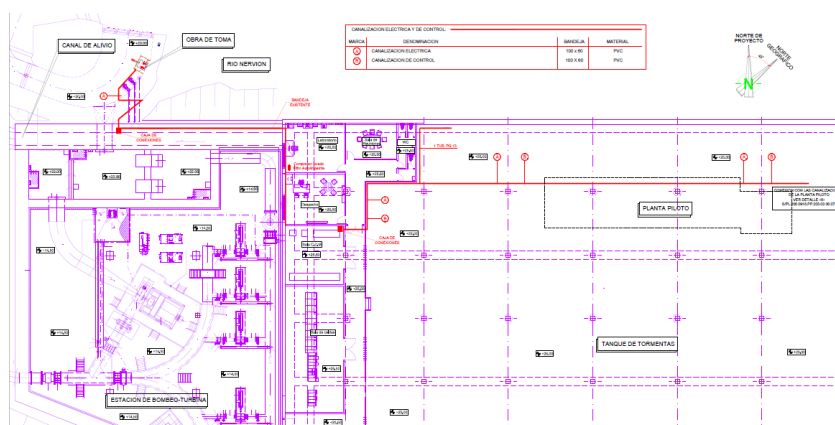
Plano con el recorrido de las bandejas de fuerza y control para la planta piloto, en la ubicación actual
